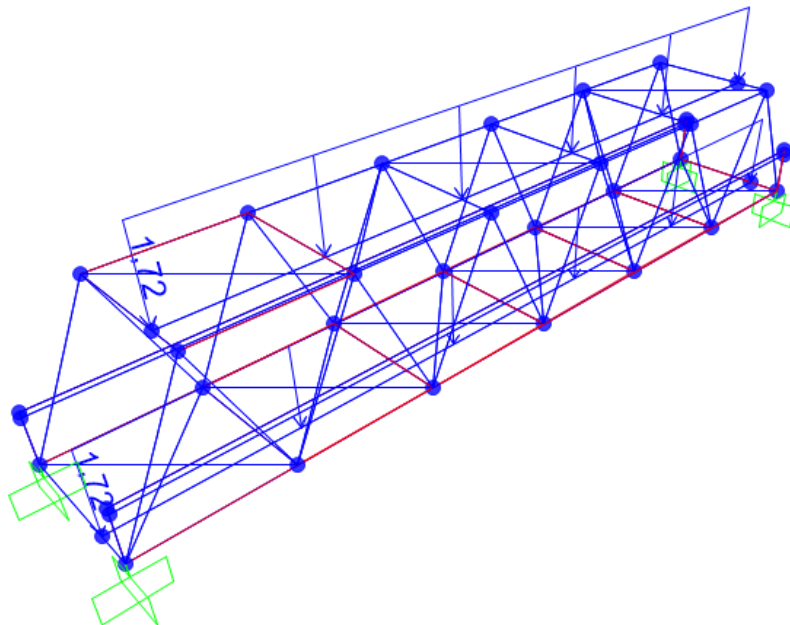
Aplicación de cargas de viento empuje vertical descendente.
